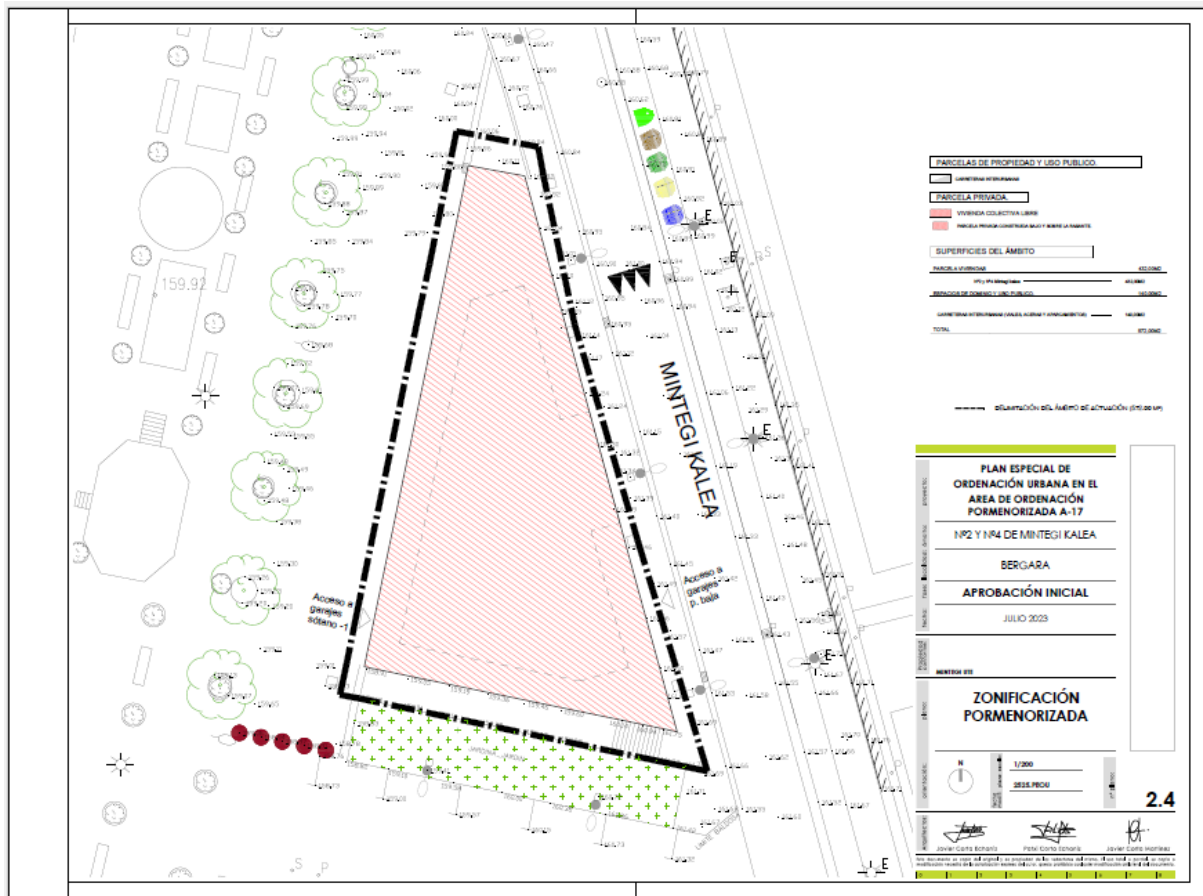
Plano 2.4 Zonificación Pormenorizada del Plan Especial de Ordenación Urbana.
